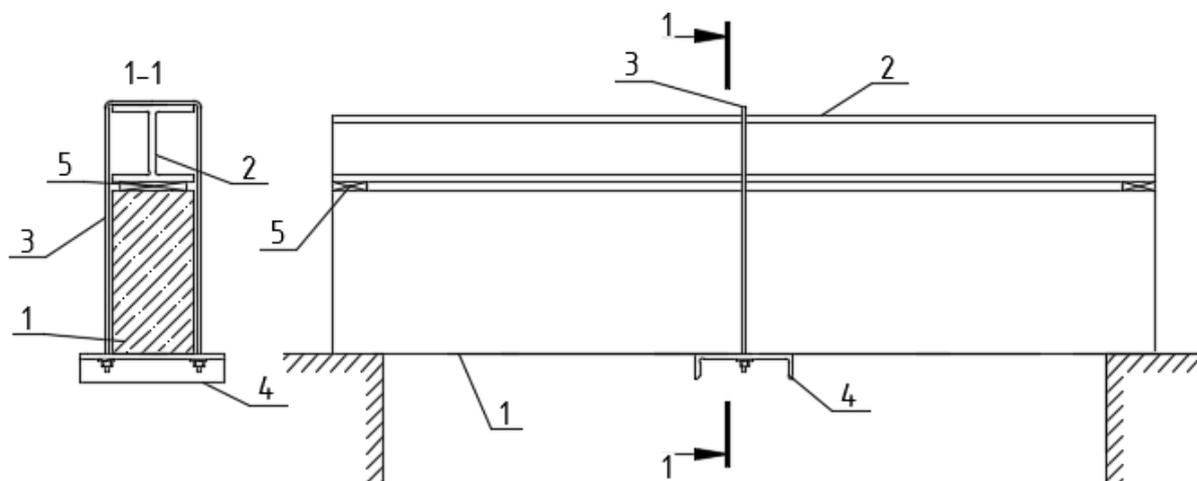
Усиление железобетонной балки упругой опорой сверху:
